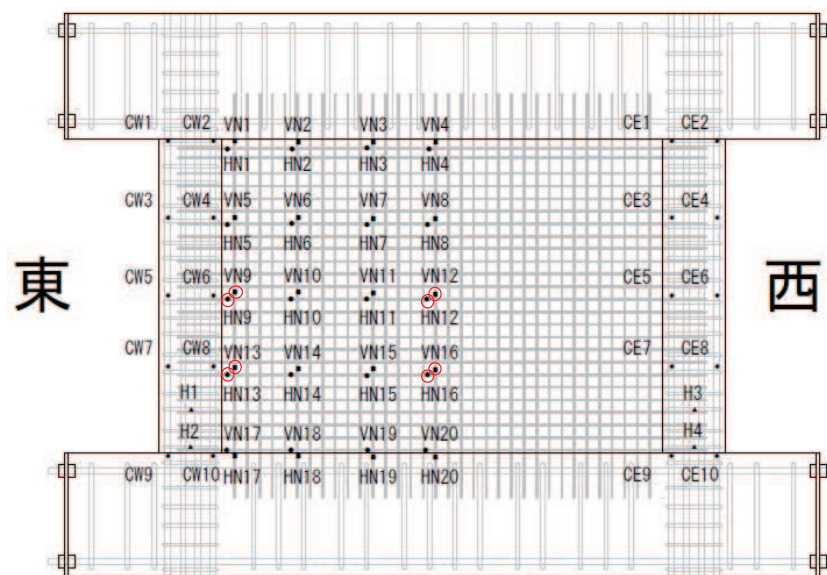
試験体 S-13-DIV 事前加力終了時 (6/1000rad.) ひび割れ図
